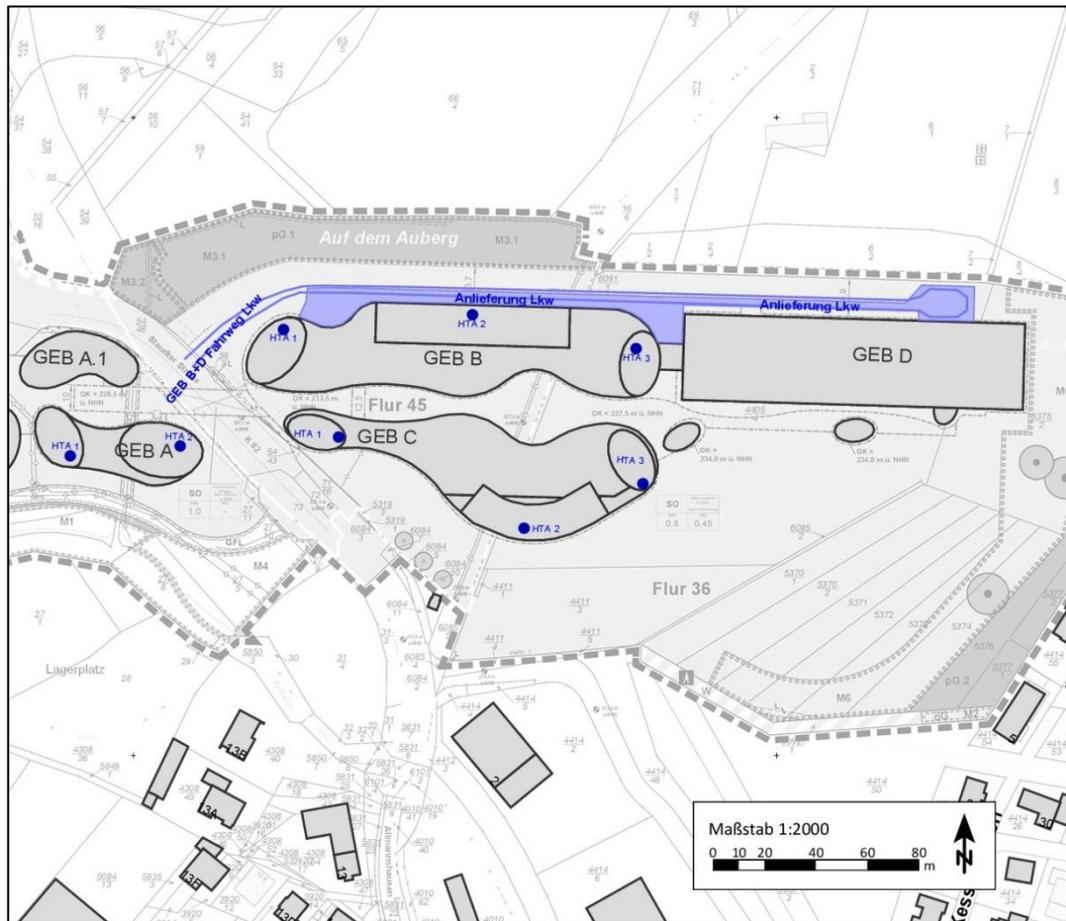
Lageplan relevante Schallquellen, FOC östl. Staudter Str., Tag
